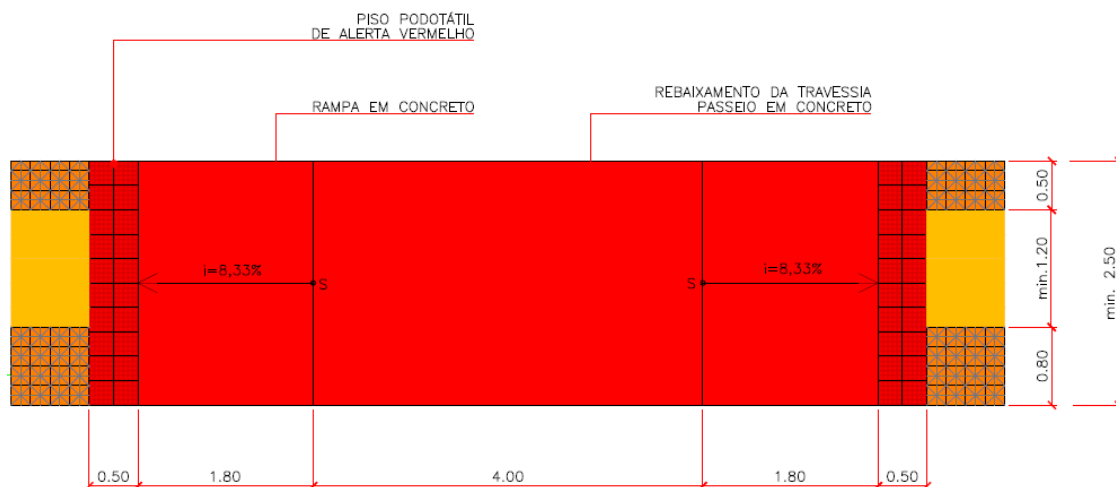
Detalhe típico de rebaixamento de calçada em região de travessia zebrada
